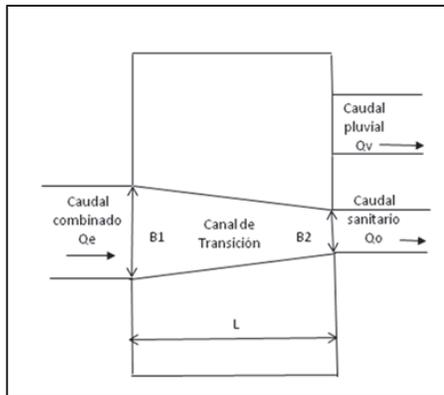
Esquema de la estructura de derivación de vertedero longitudinal en planta.
